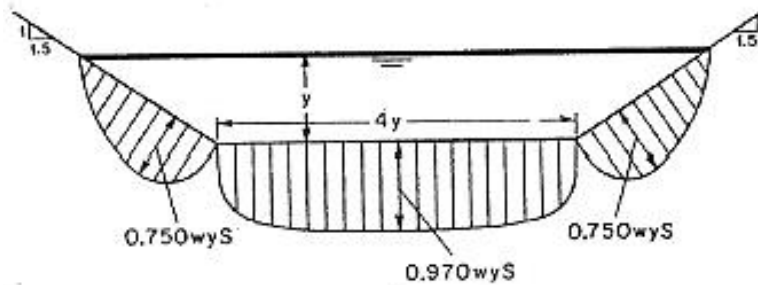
Distribución de la fuerza tractivas o tangencial sobre las paredes de un canal trapezoidal.
